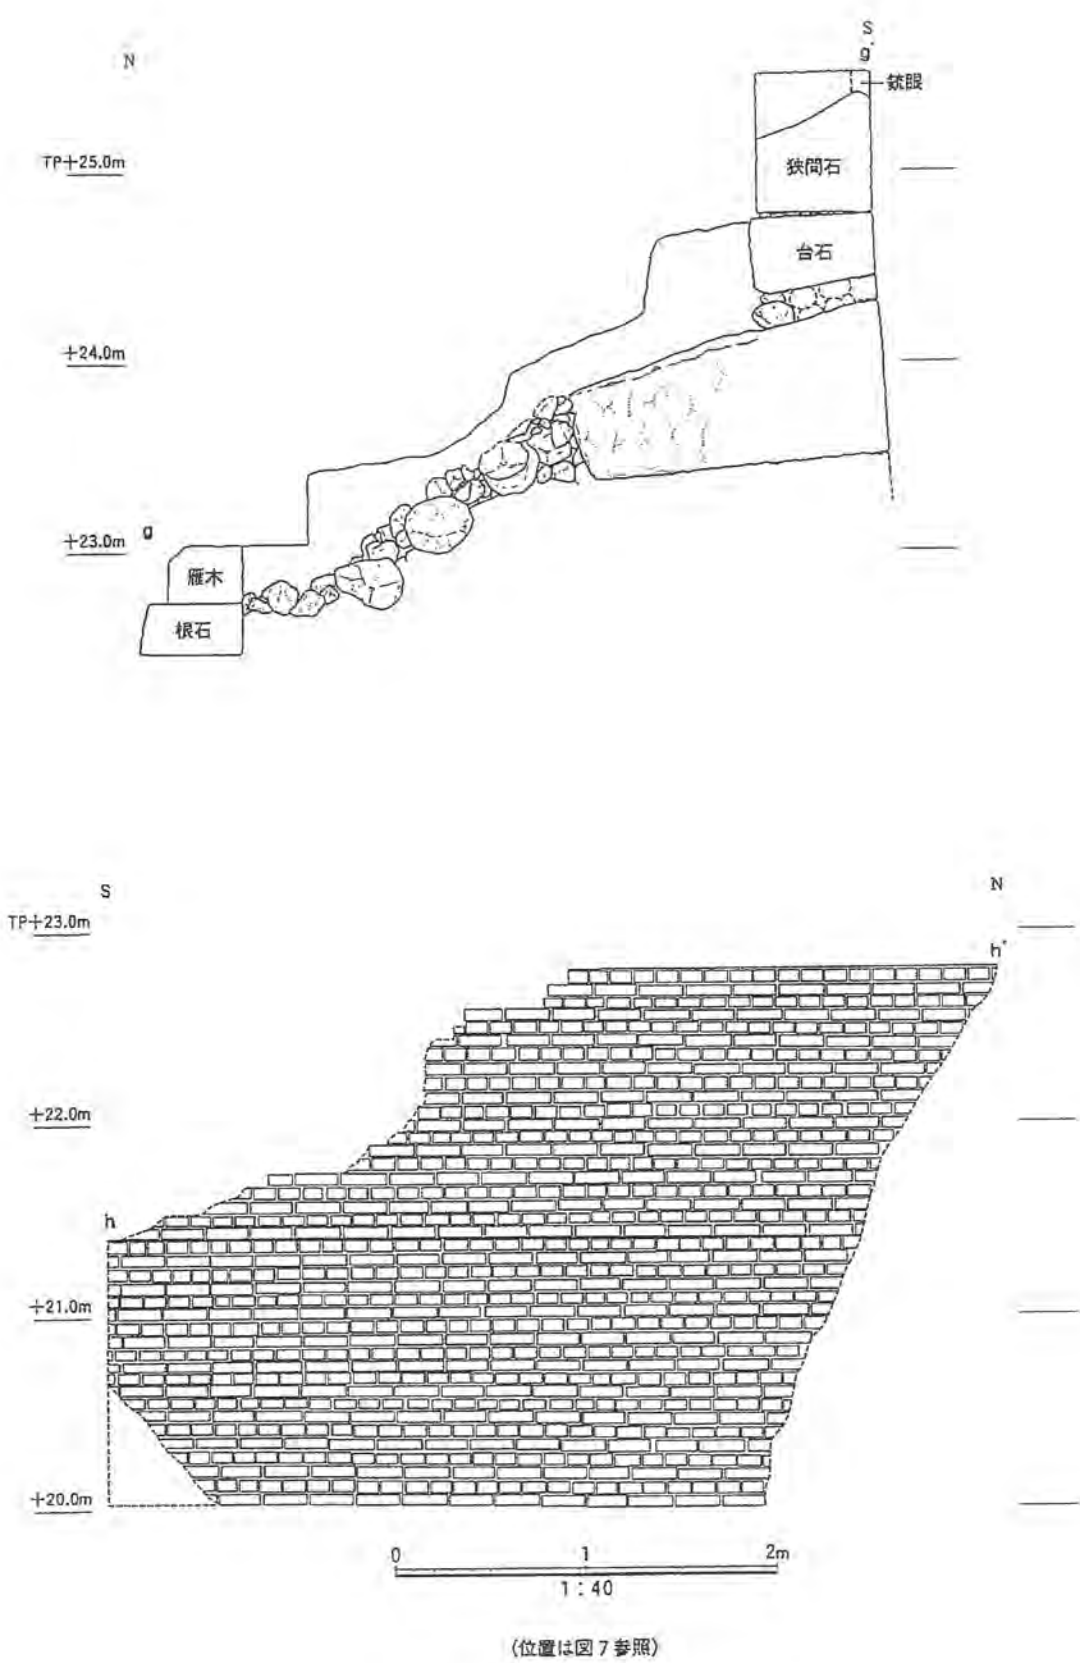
南区 裏込め断面図(上)と煉瓦建物東壁立面図(下)
